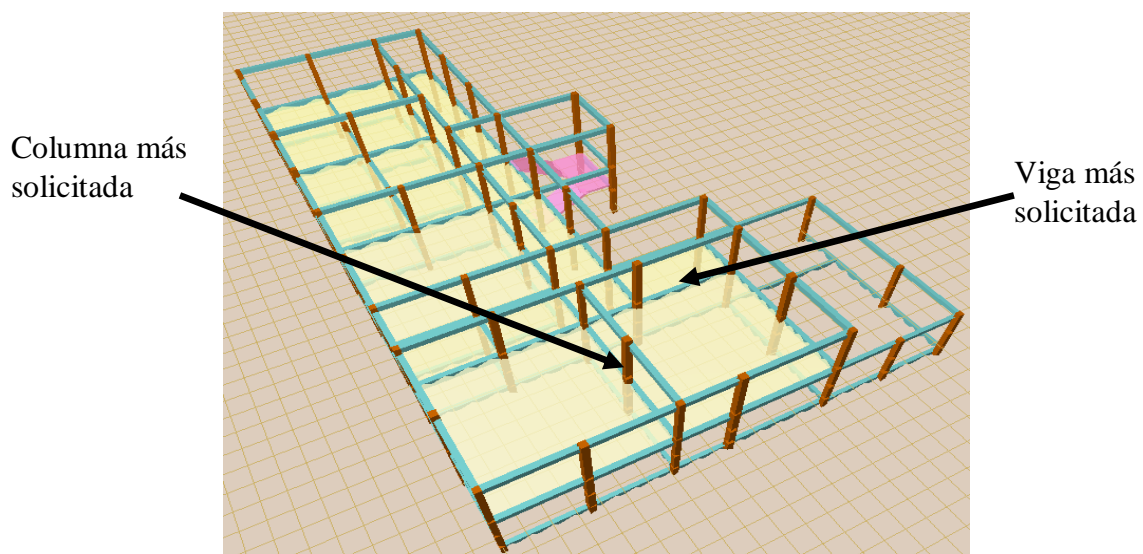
Ubicación viga y columna más solicitada del Bloque Aulas
